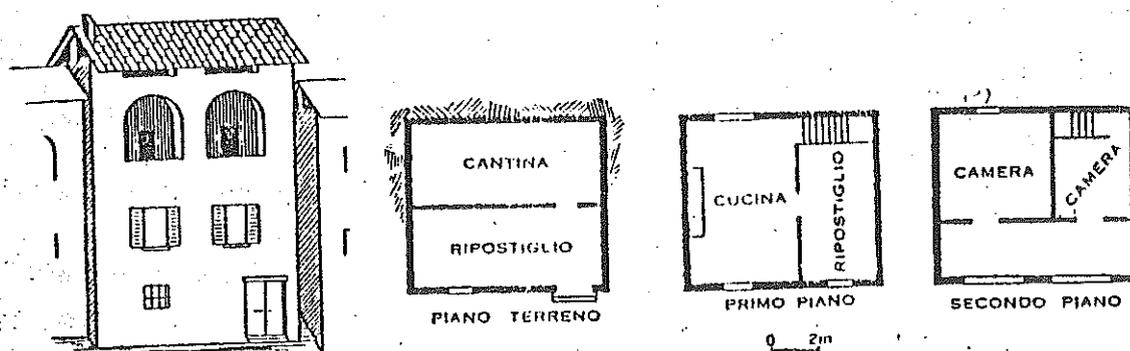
Prospetto e planimetria di abitazione rurale nella fascia agricola del Ceresio.
